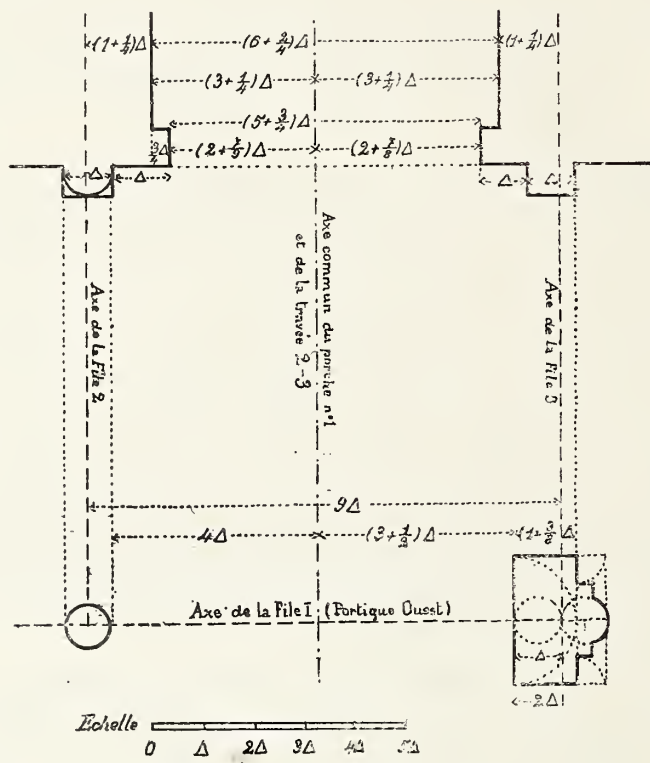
Plan de l'entrée Ouest de la travée 2-3.
